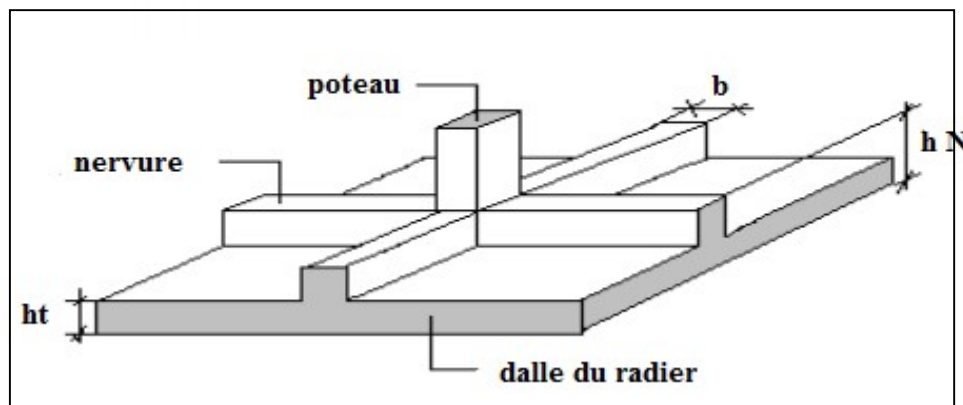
Disposition des nervures par rapport au radier et aux poteaux
